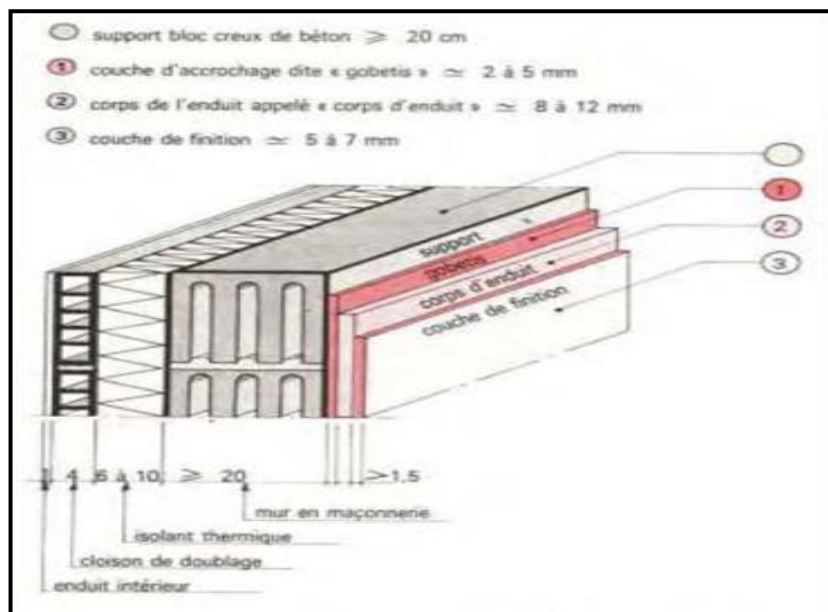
Couches d'un enduit traditionnel au mortier hydraulique.
